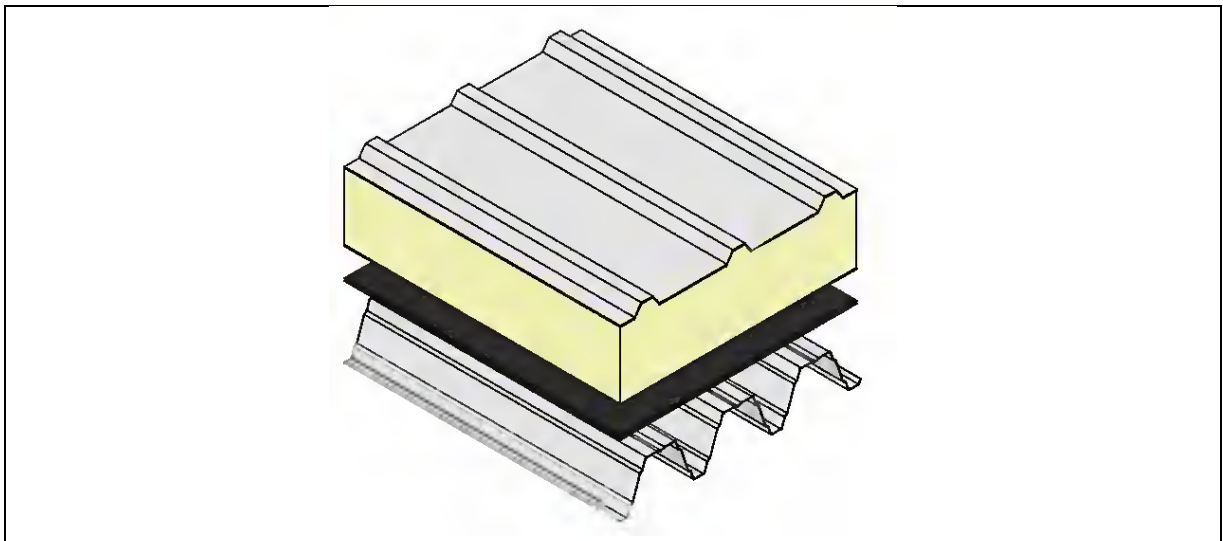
Sanierung Trapezdach mit Sandwichelement
